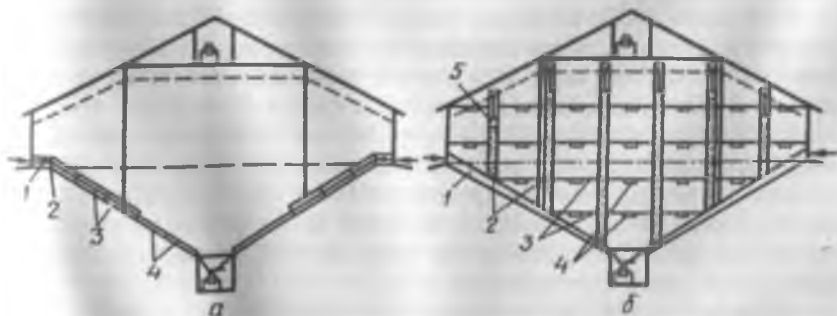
Схема стационарных установок для вентиляции зерна в складах с наклонными волами:
